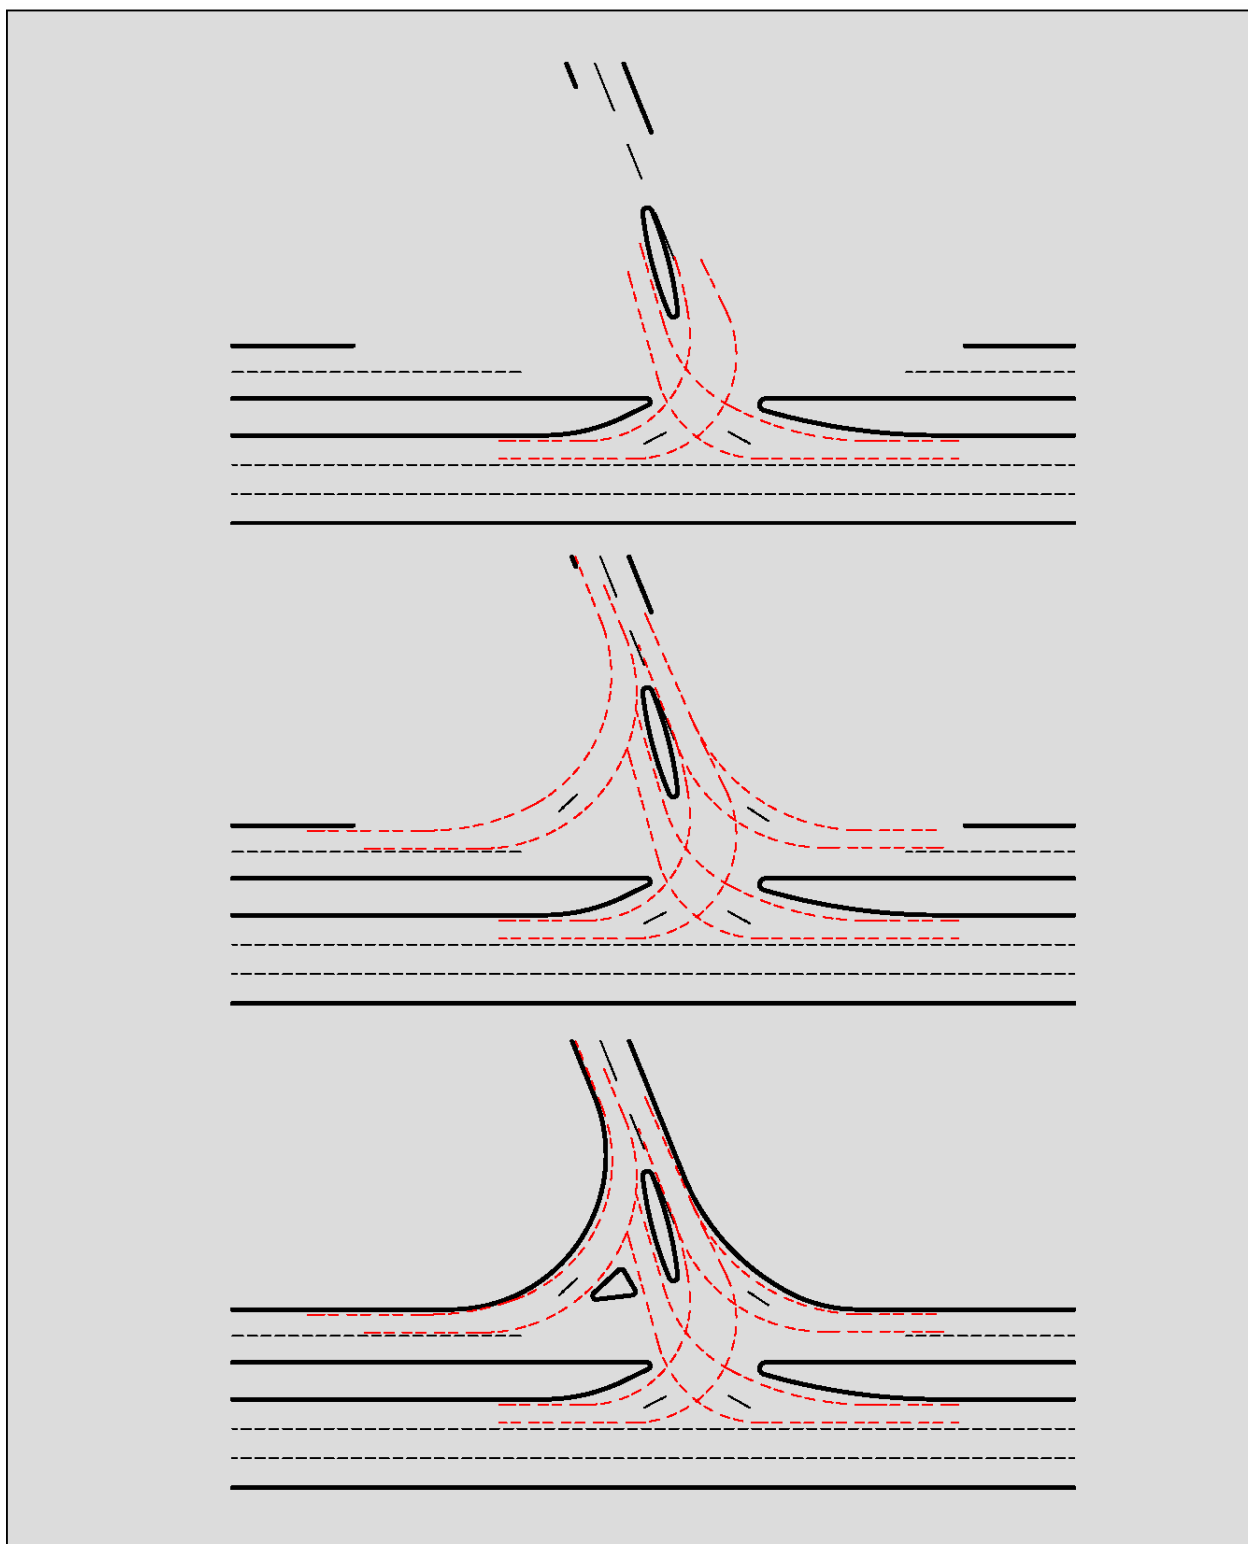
Desenvolvimento da canalização para ajustes às trajetórias de giro
